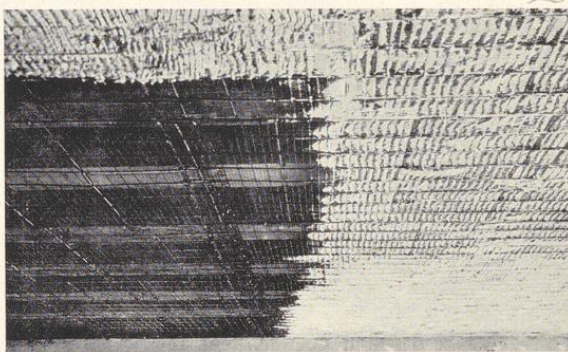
Baustahlgewebe an Holzbalken direkt befestigt, teilweise ausgedrückt
